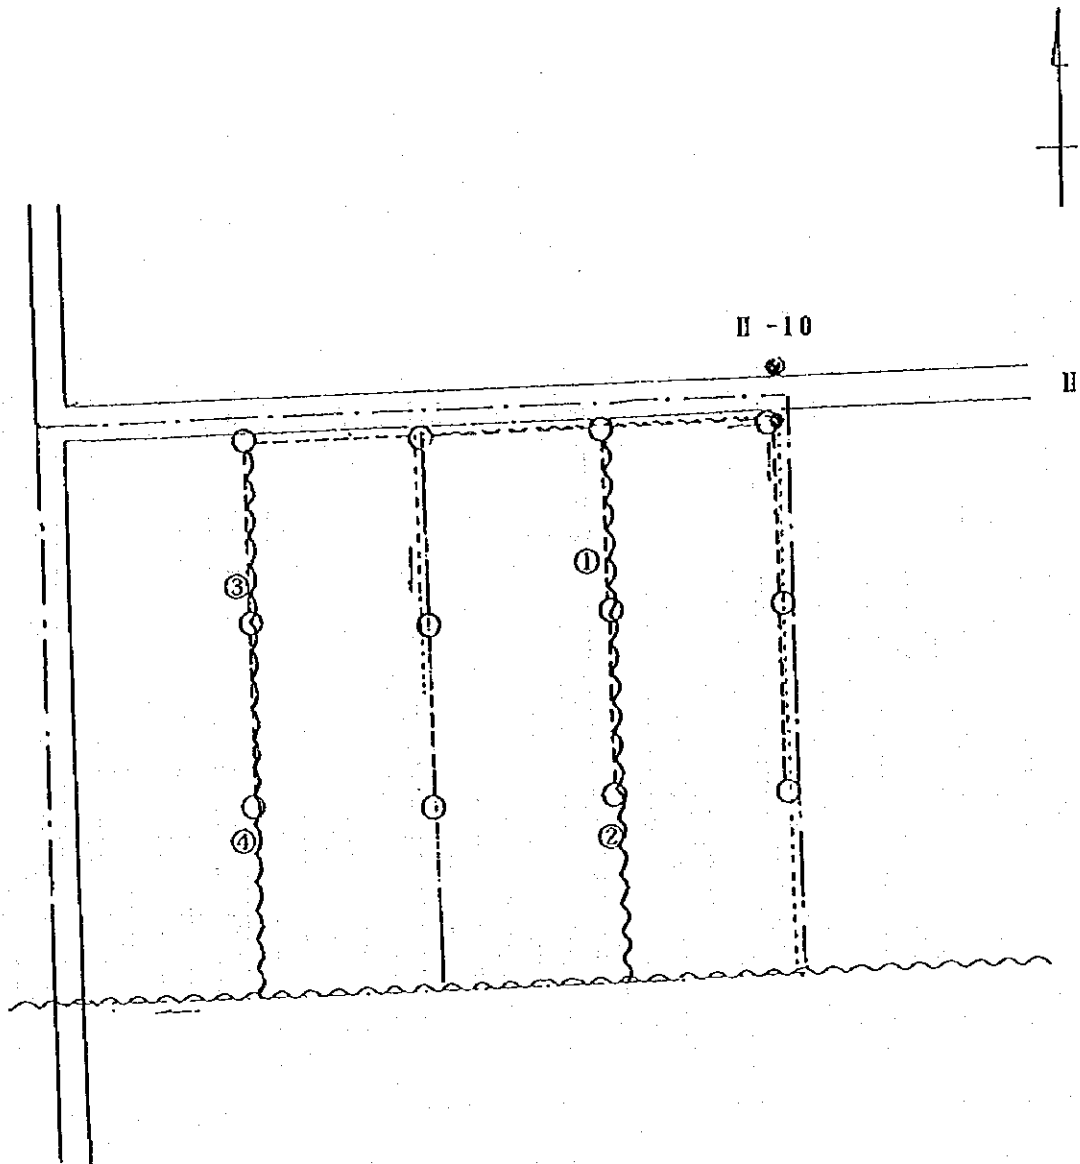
Plan horizontal du projet des installations terminales (Tozeur)
